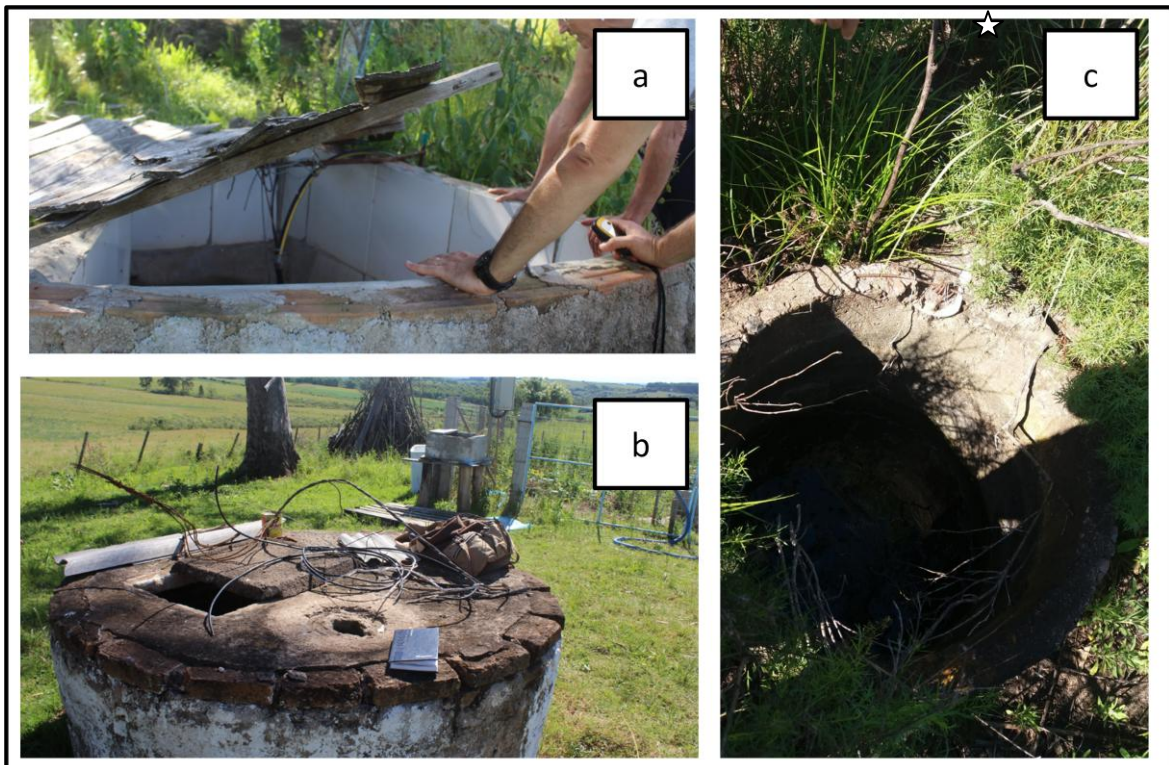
a) Caixa de proteção a nascente; b) poço escavado 1 e c) poço escavado 2.
